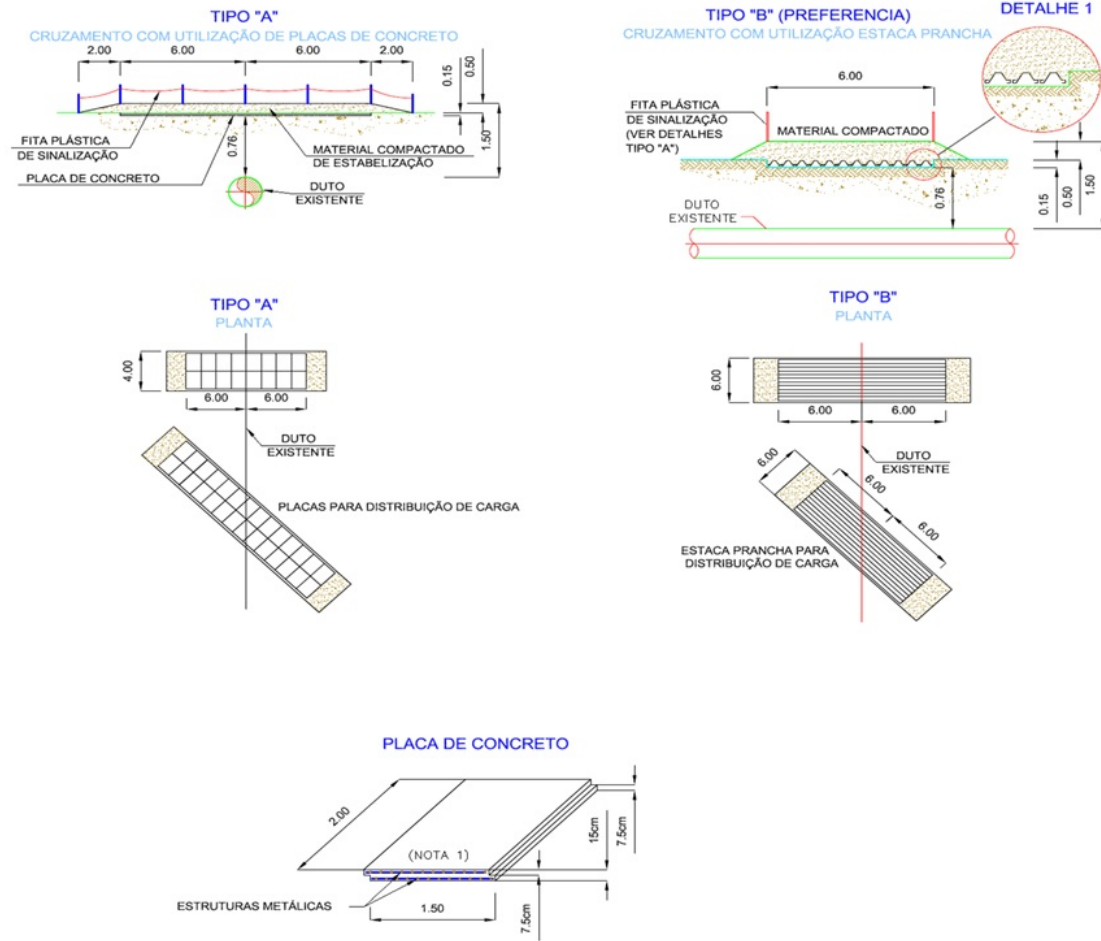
Detalhe do sistema construtivo de sobrecarga.
